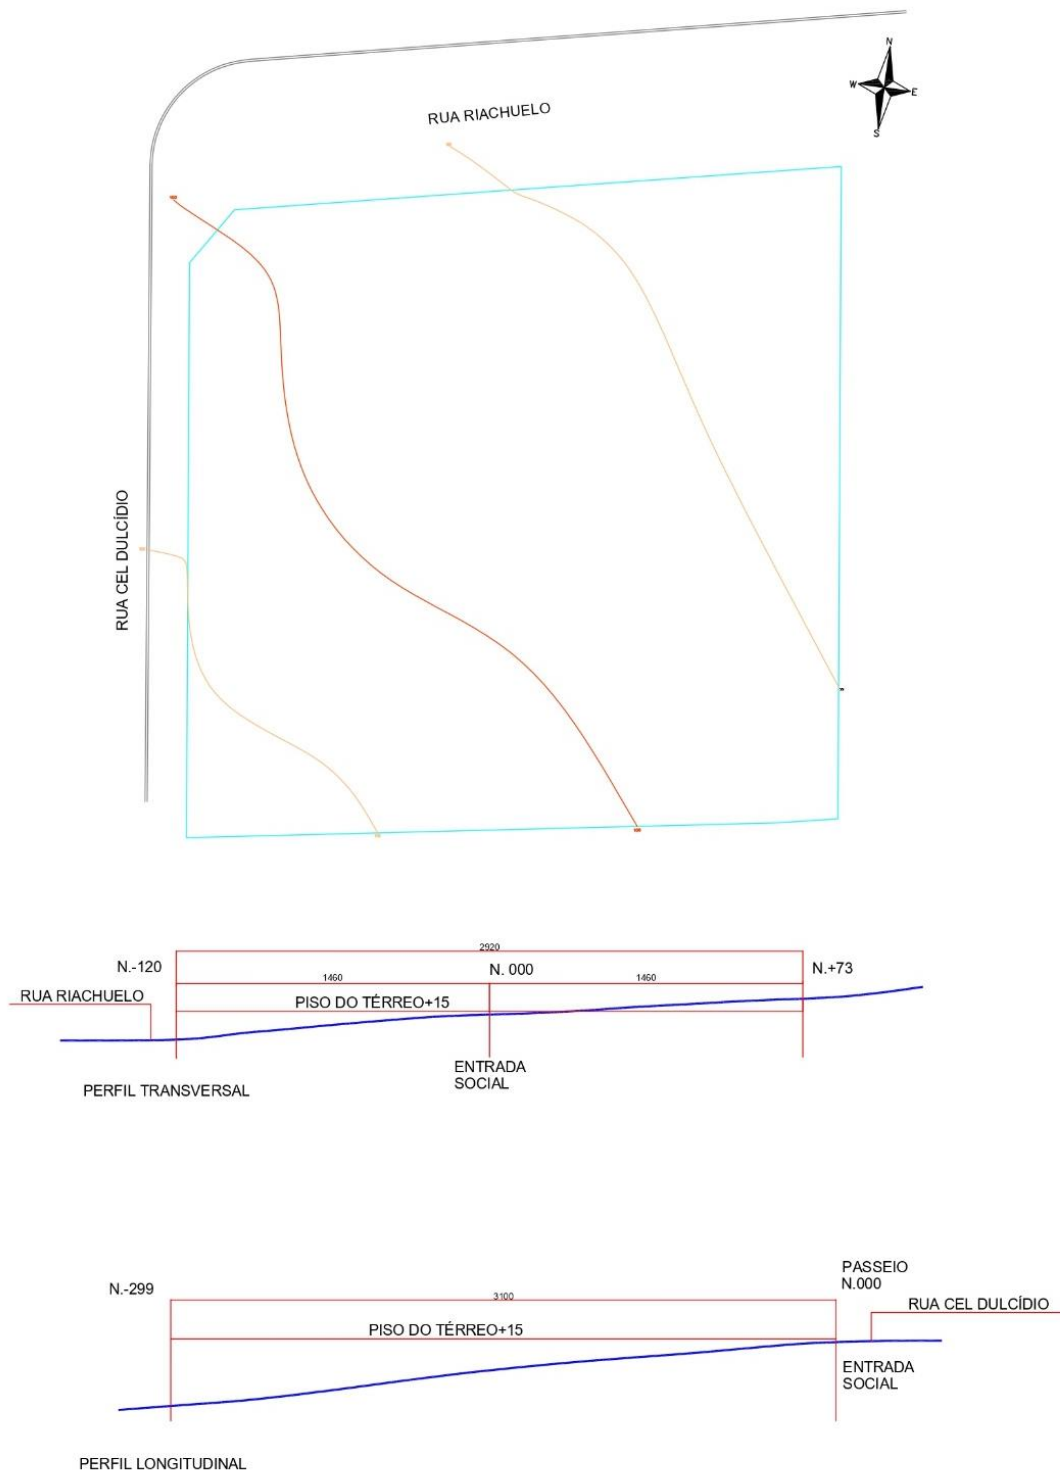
Levantamento Planialtimétrico e perfis longitudinal e transversal.
